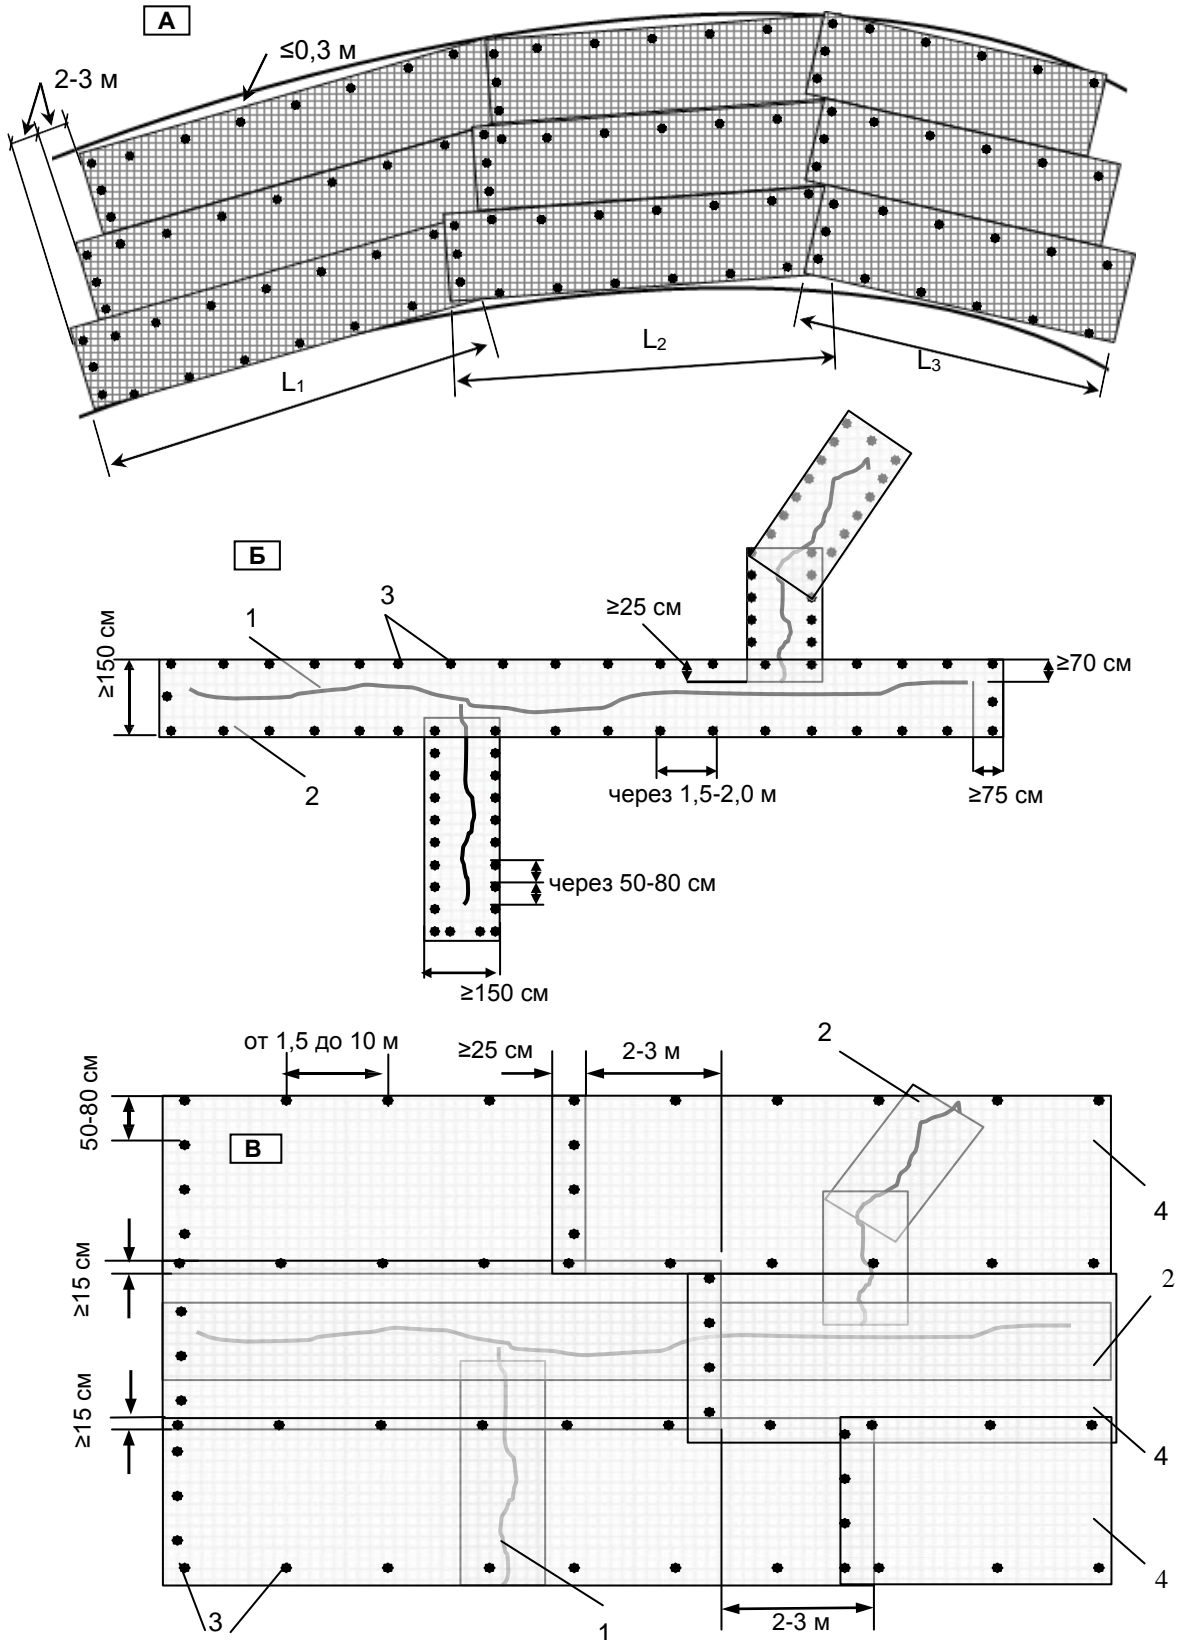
Схемы укладки и крепления полотен и полос геосетки на основании:
